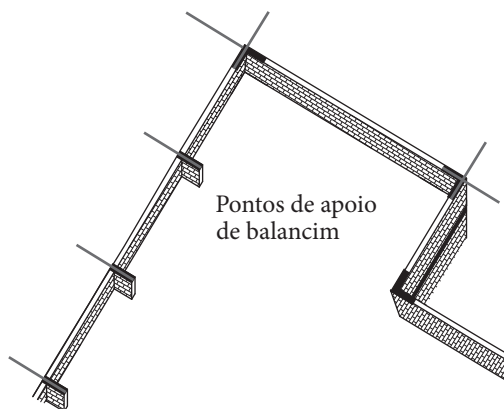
Balancim apoiado nos cantos de platibanda em alvenaria e em enrijecedores de alvenaria.
